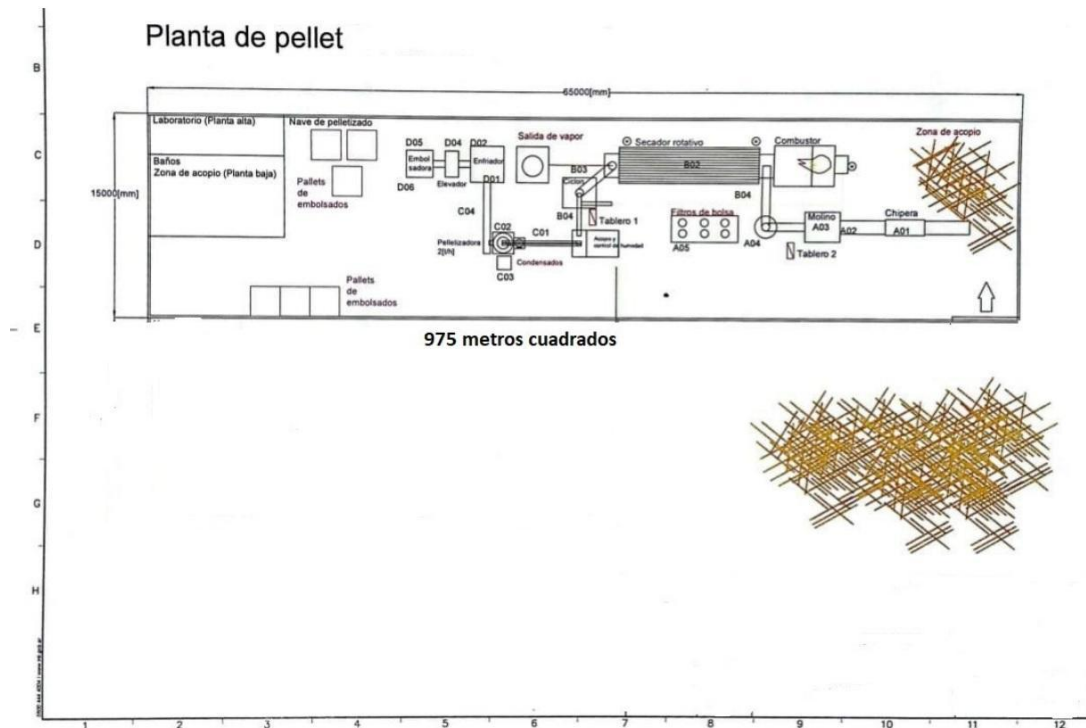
Layout de planta peletizadora. Elaboración de la empresa.
